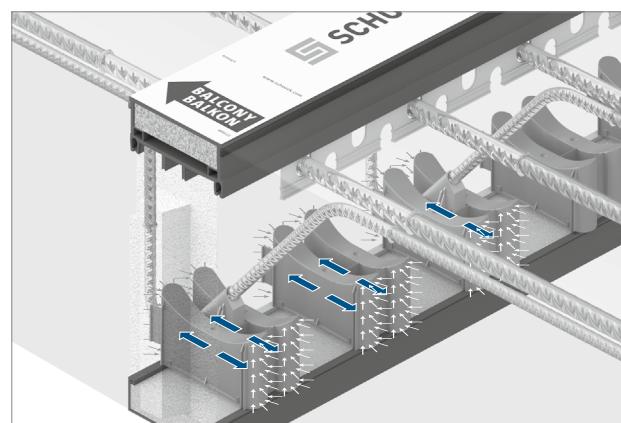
Schöck Isokorb® T tip KL: priprava opaža in armature za betoniranje. Stik vgrajenega betona na steni = spodnji rob opaža balkona!
